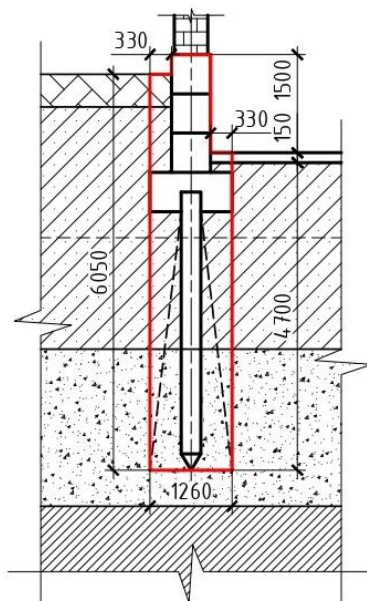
Схематичне зображення фундаменту під зовнішню стіну
